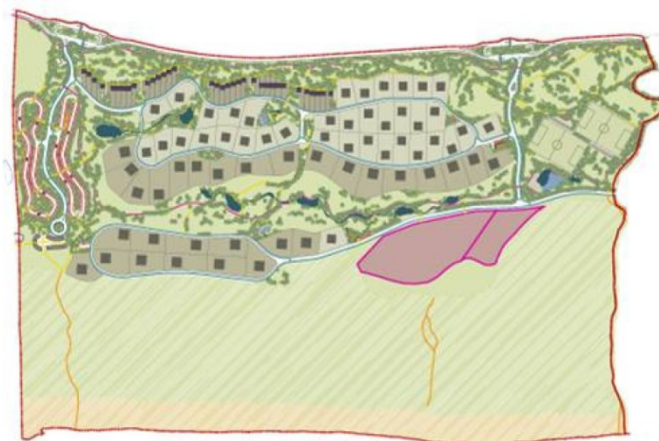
Plano de pormenor da UNOP 7 – núcleo turístico Sol-Norte, planta de implantação. Fonte: Câmara Municipal de Grândola
